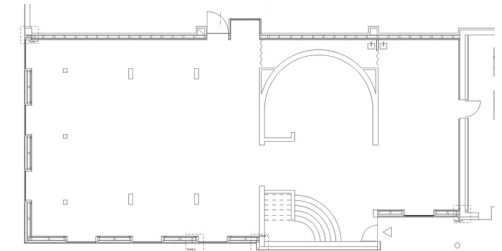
Pianta piano terra; Fonte: www.archinfo.it;
